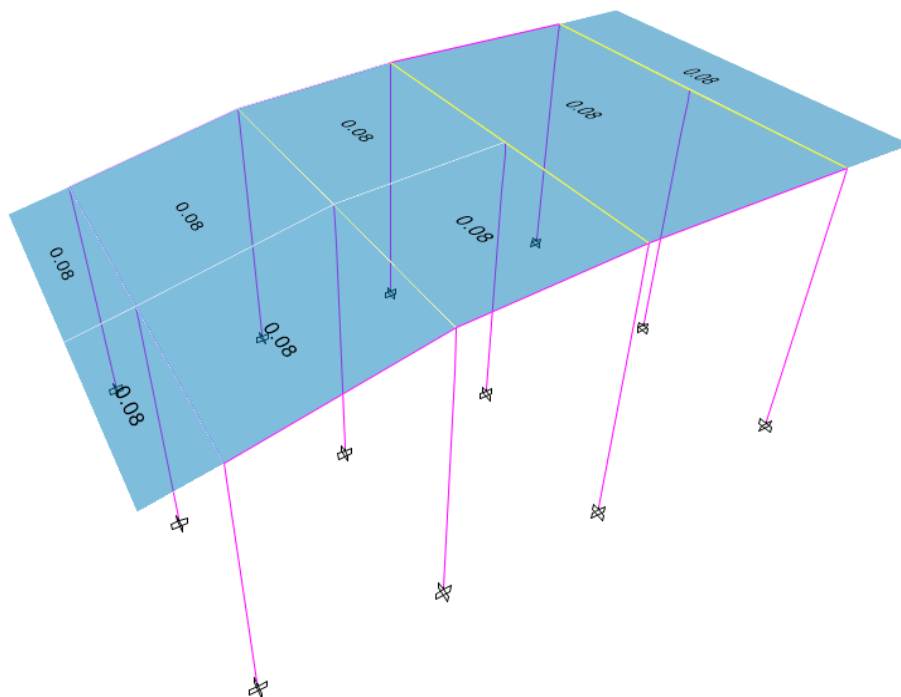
Vista en planta y 3d modelada (Edif. N° 04 – SS. HH piscina)
